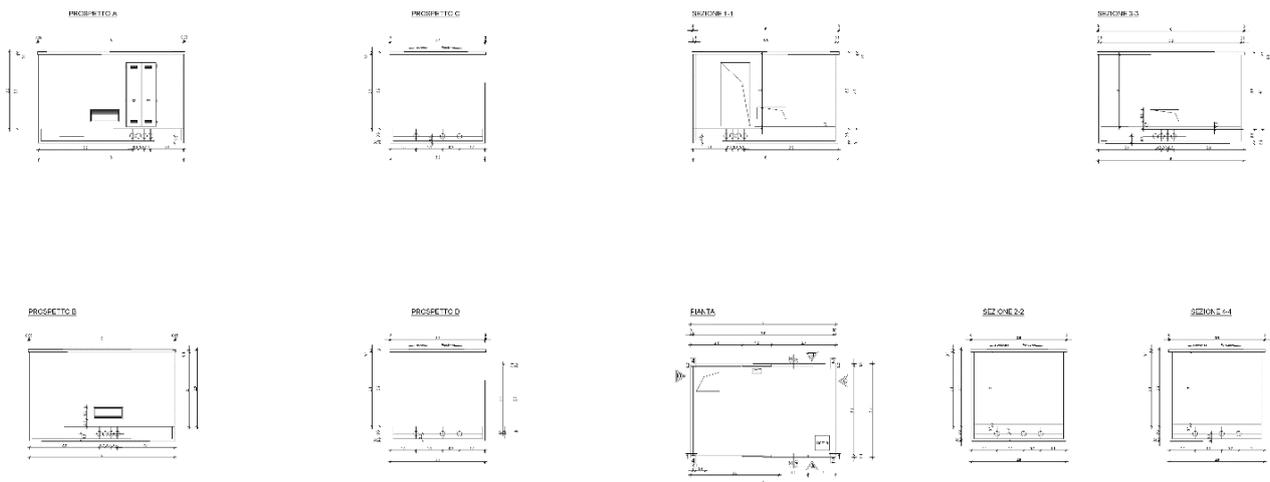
prospetti, sezione e pianta delle cabine di sottocampo.
